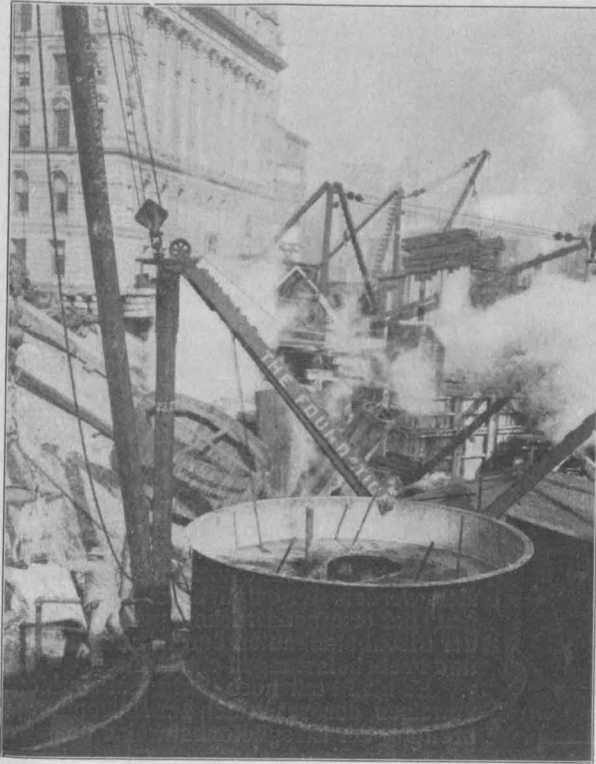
Kaissongründung für ein zwölfstöckiges Gebäude der Stadtverwaltung in New York.
